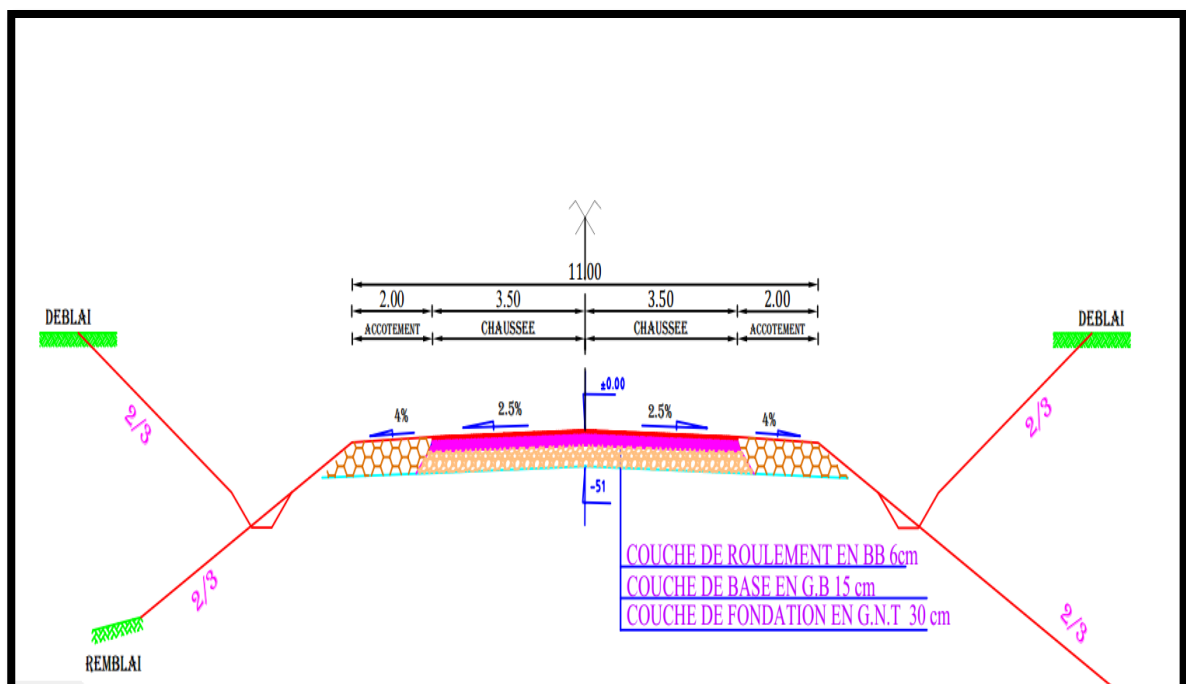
Profil en travers type (chaussée bidirectionnelle)
